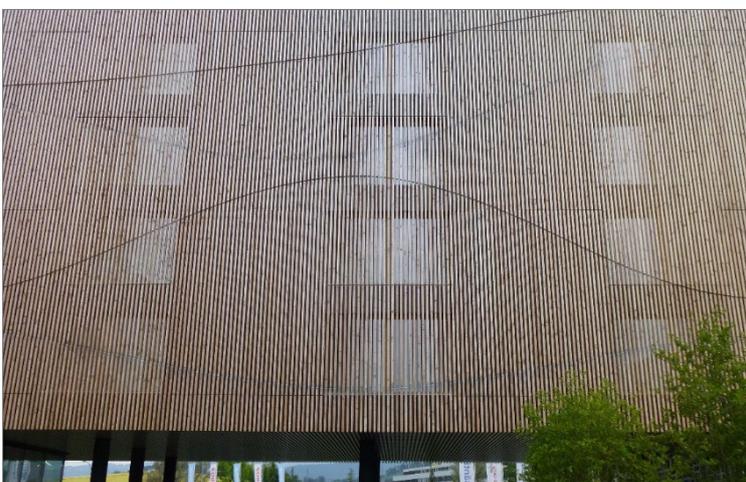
Fassaden mit «offener» Holz-Aussenwandbekleidung. Der Witterungsschutz muss durch die darunterliegende, wasserführende Schicht gewährleistet werden; Hotel Sântispark Abtwil; Carlos Martinez Architekten, Berneck
